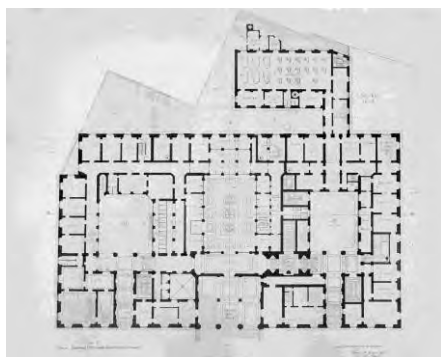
progetto Piacentini Banca d'Italia pianta piano terreno
